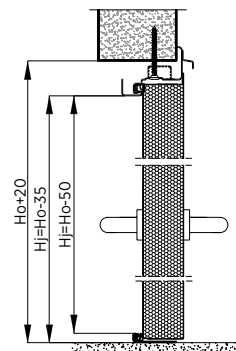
Montage zweiflügeliger Türen mit Eckzarge an der Stahlkonstruktion - Vertikalschnitt
